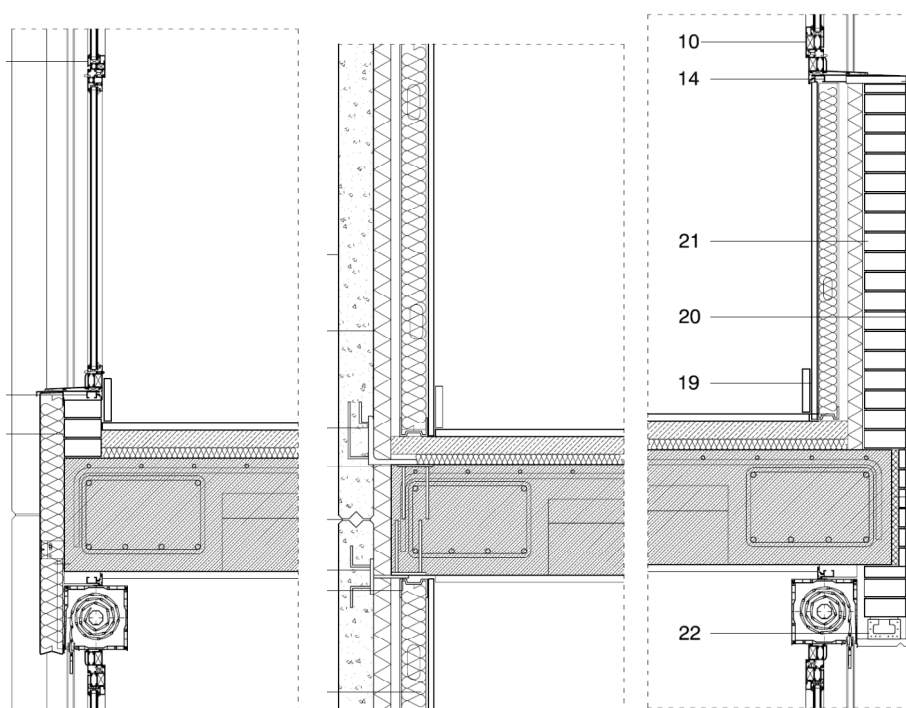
Solución de encuentro de forjado con fachada de una promoción de VISESA. Derecha, fachada mediante elementos prefabricados de hormigón armado, sección por paneles y sección por ventanas. Izquierda, solución de fachada hacia patio mediante raseo de mortero monocapa y trasdosado de placa de yeso. Proyecto de 108 viviendas VPO y 48 sociales en la parcela A.I.U. I.B.20, Iza-Ibaeta, Donostia-San Sebastián. Joseba Fernández Beldarrain y Enrique Muga Francisco (SATIE S.L.).
